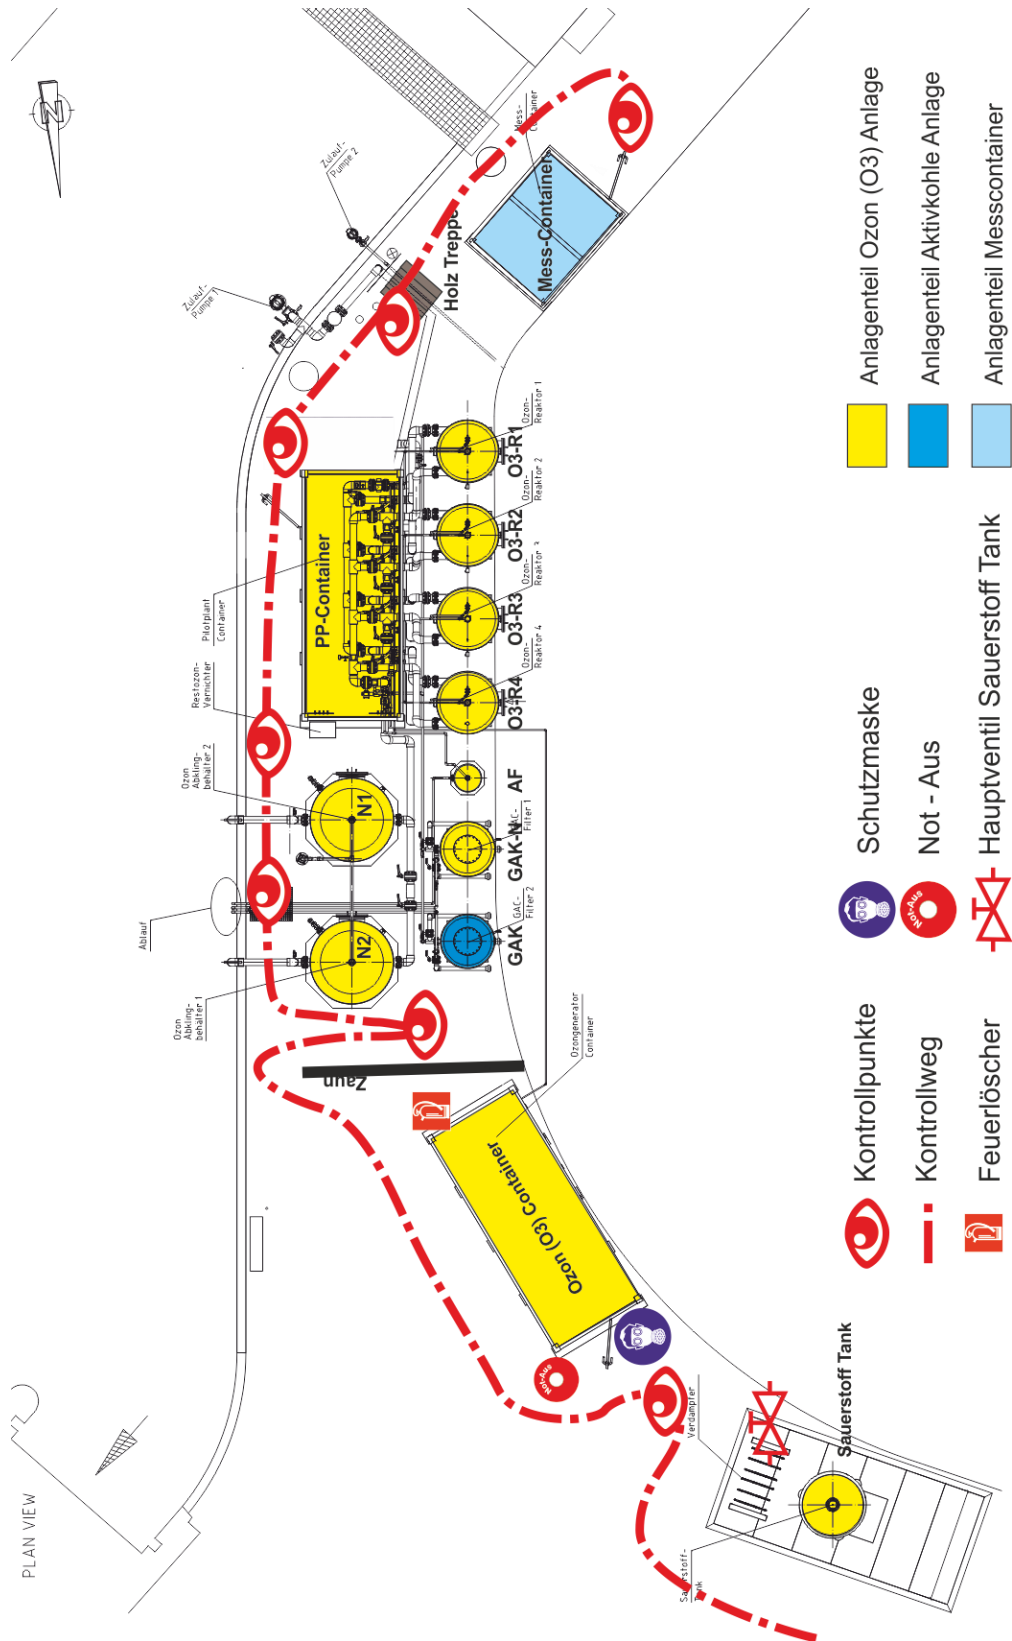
Grundriss Versuchsanlage sowie Weg der Routine-Inspektion
